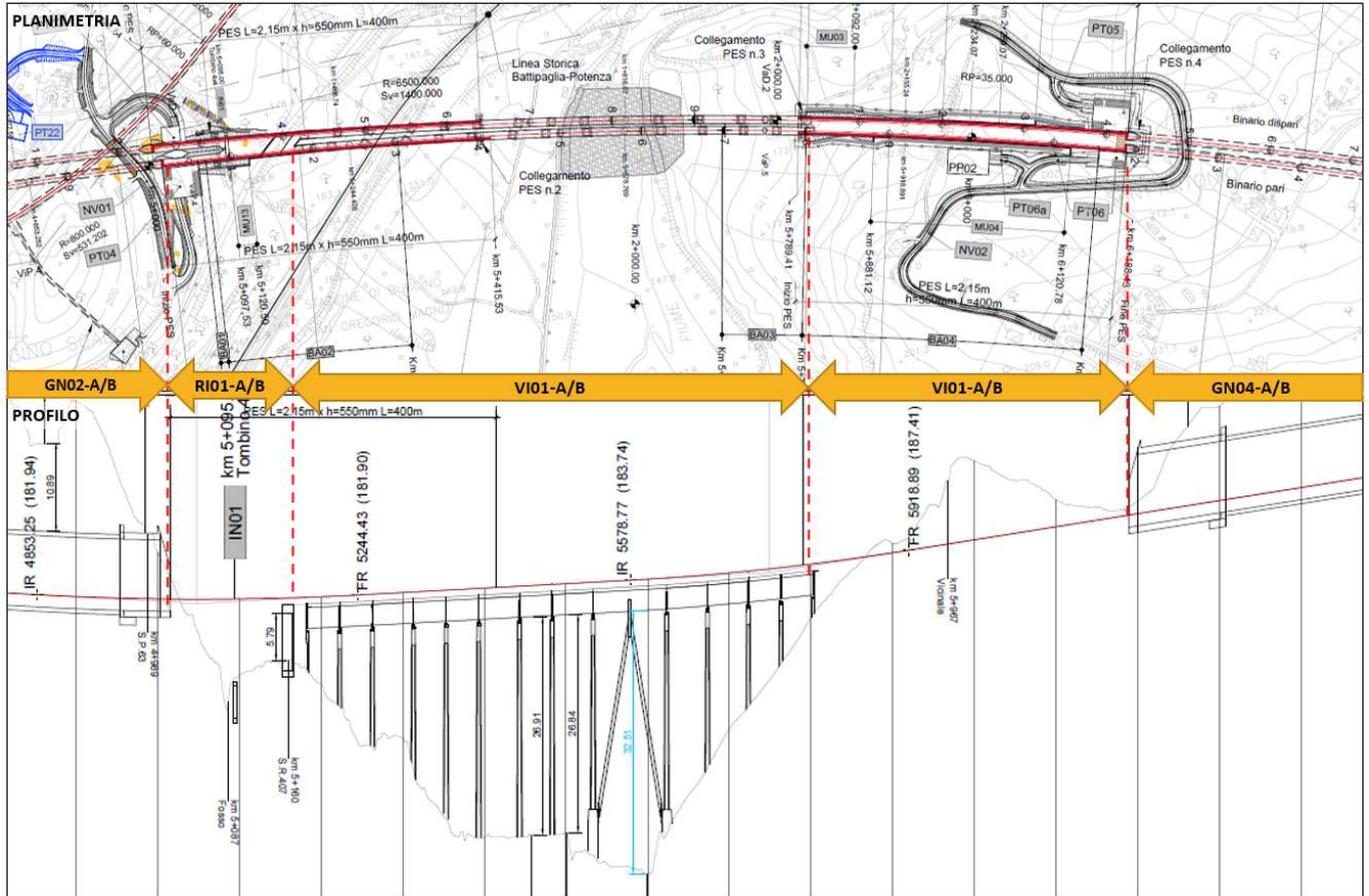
Stralcio planimetrico con individuazione piazzali disconnessione fumi
